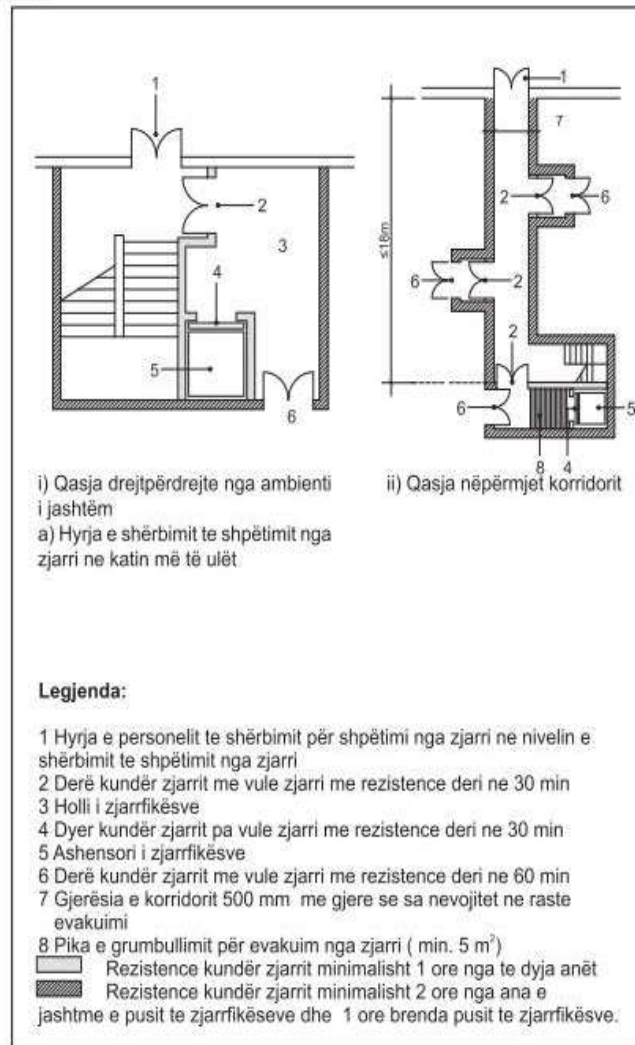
Planimetria tipike e kafazit të shkallëve për evakuim.
